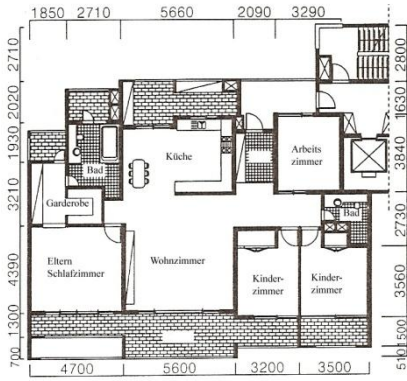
Grundriss der II-San-Wohnhochhaus-Siedlung mit Wohnflächen von 147m² und 145m²
